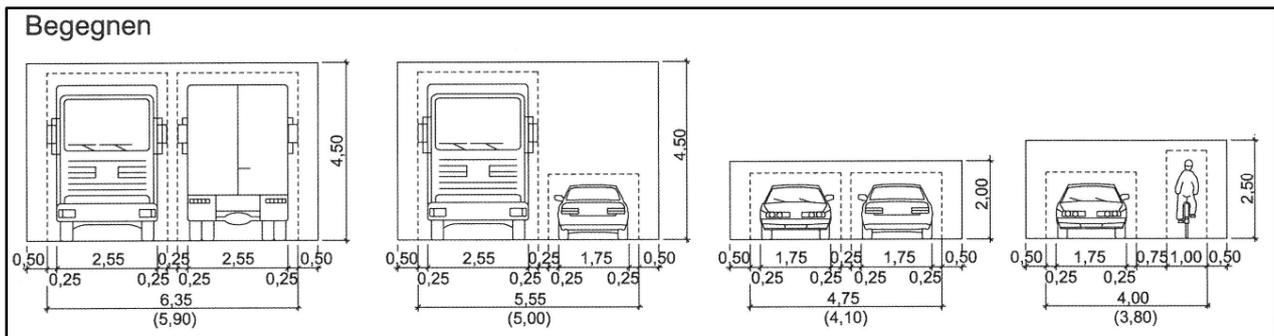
Auszug aus Bild 17 RASt „Verkehrsraum und lichter Raum beim Begegnen (Klammermaße: mit eingeschränkten Bewegungsspielräumen)
